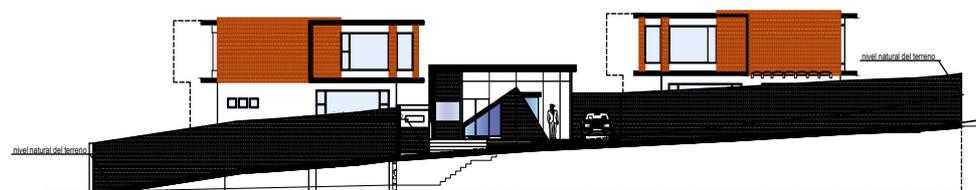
Fachadas Residencias Briza Elaborado por David González
